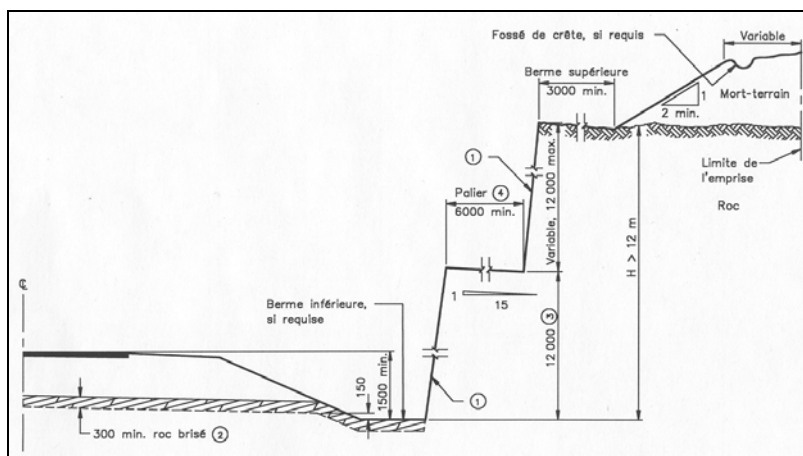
Section type d'une coupe de plus de 12 mètres de hauteur.
